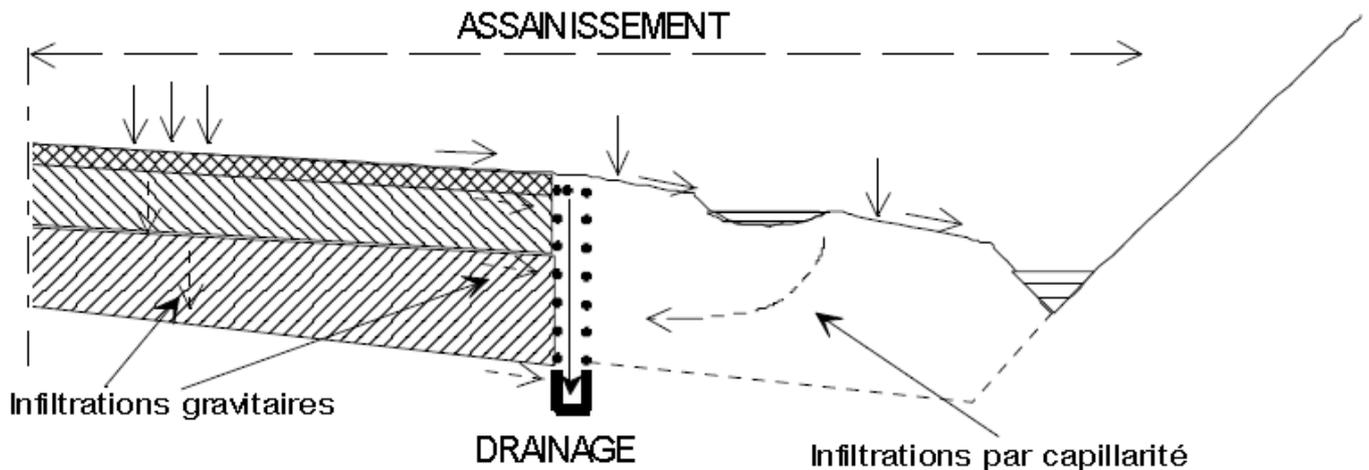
distinction entre les fonctions de drainage et d'assainissement routier
